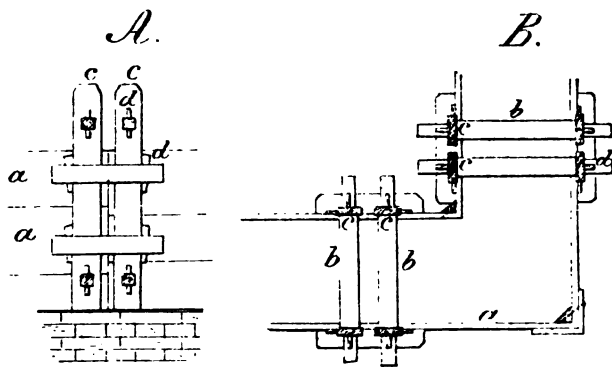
Seitenansicht A und Grundriss B einer Wandform für Kalksand-Büfmauern. a Wandhöhlen, b Riegelstößer, c Leistenstößer, d Holzkeile.
